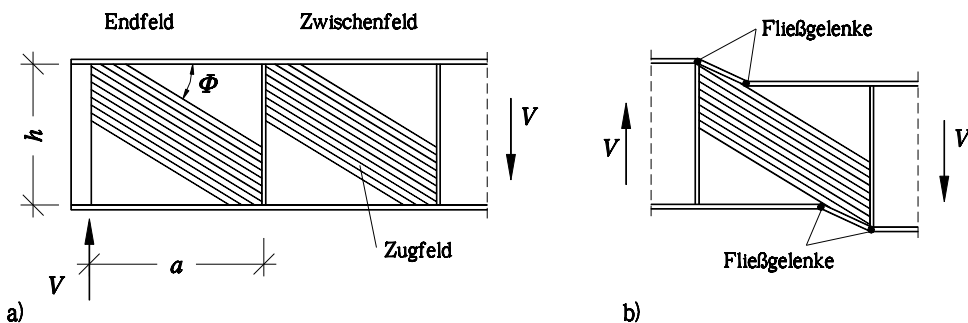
Träger mit Quersteifen: a) Ausbildung von Zugfeldern, b) Versagensmechanismus
